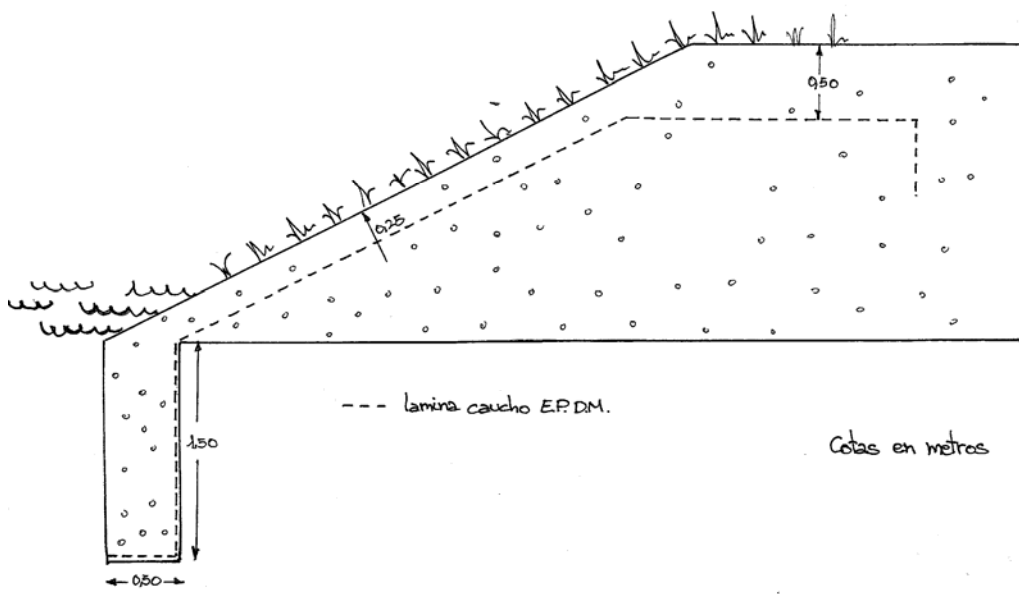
Croquis de la colocación de la manta aislante en el dispositivo de corrección de la zanja longitudinal
